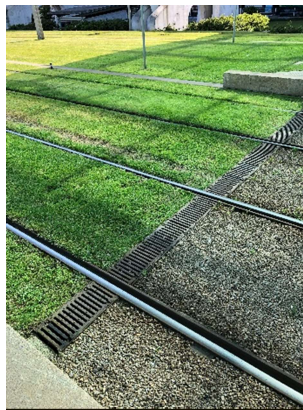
Via permanente de VLT encapsulado ou com dormentes de concreto
